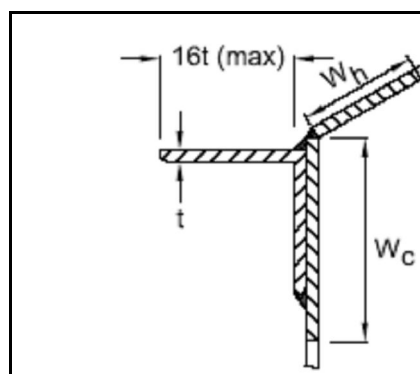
Detalles constructivos del anillo de refuerzo
